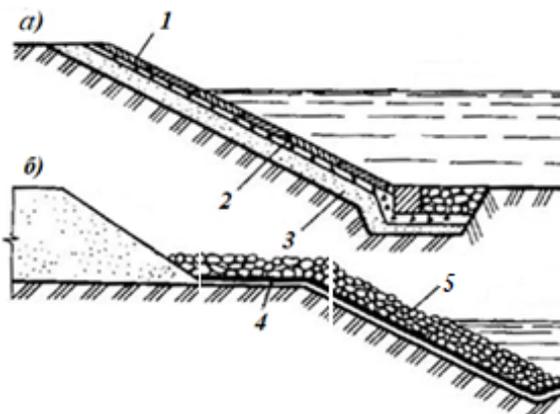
Конструкции защиты откосов: *а* – из железобетонных плит с песчаным подстилающим слоем; *б* – с прослойкой из геотекстиля; 1 – ж/б плиты, 2 – выравнивающий слой из щебня, 3 – подстилающий слой из щебня, 4 – геотекстиль, 5 – каменная наброска, УВВ – уровень высоких вод
